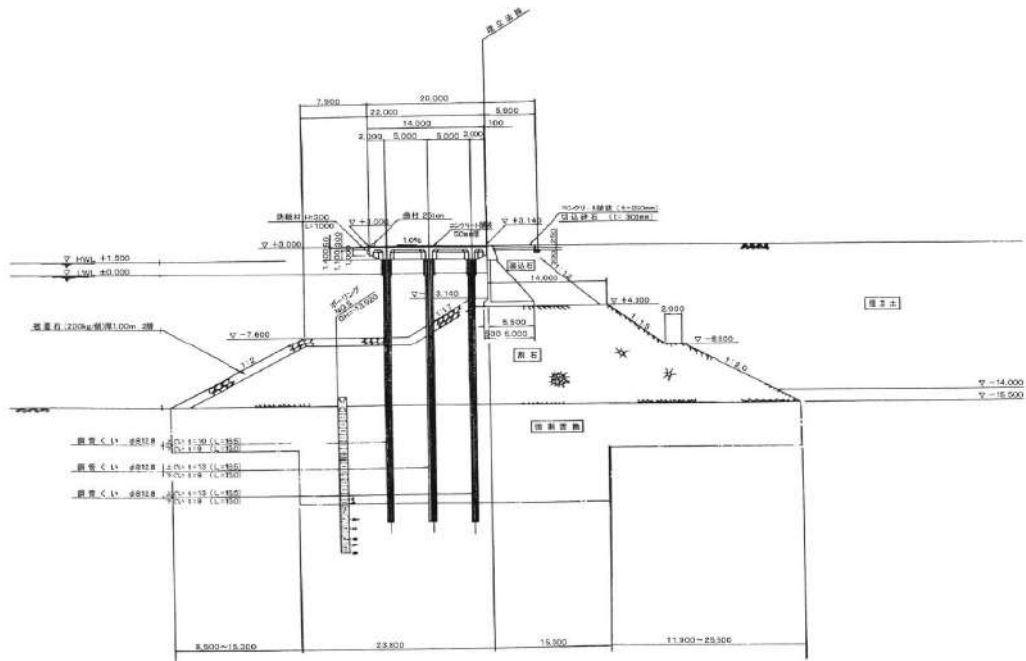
野々田地区栈橋 (-7.5m) の標準断面図
